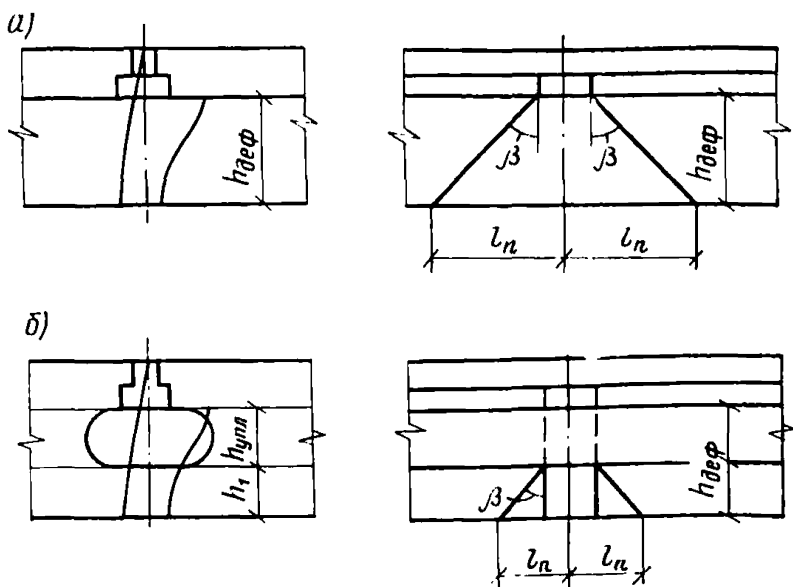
Схемы для определения полудлины участка неравномерной просадки грунта от нагрузки фундамента
